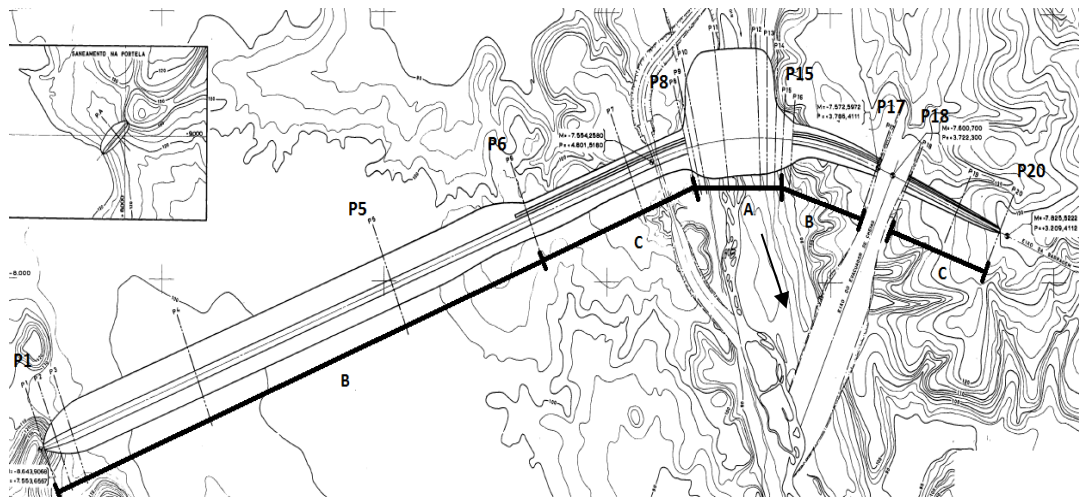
Planta da barragem de Massingir (COBA, 1969 d)).
